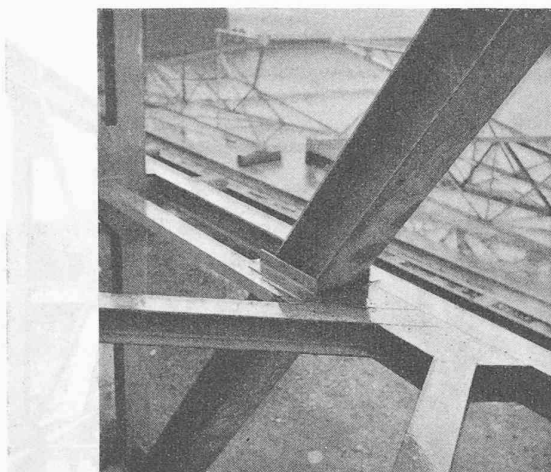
Passage d'une diagonale de poutre principale au travers du plan de contreventement.
